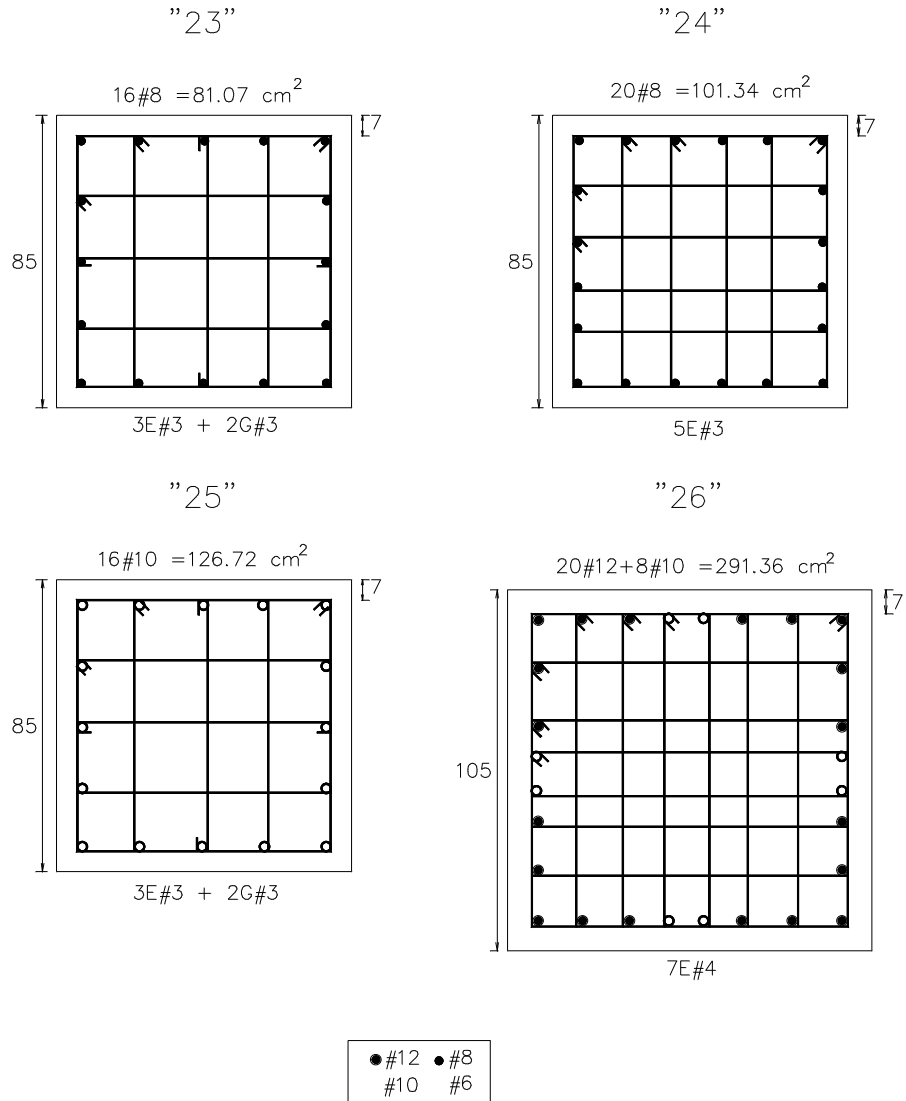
Tipos de armados propuestos para las columnas del eje 2, estructuras de 17 niveles diseñadas en zona III (RDF-93 y RDF-04)
